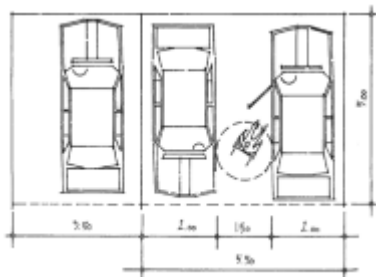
Bewegungsfläche zweier gekoppelter Parkplätze
